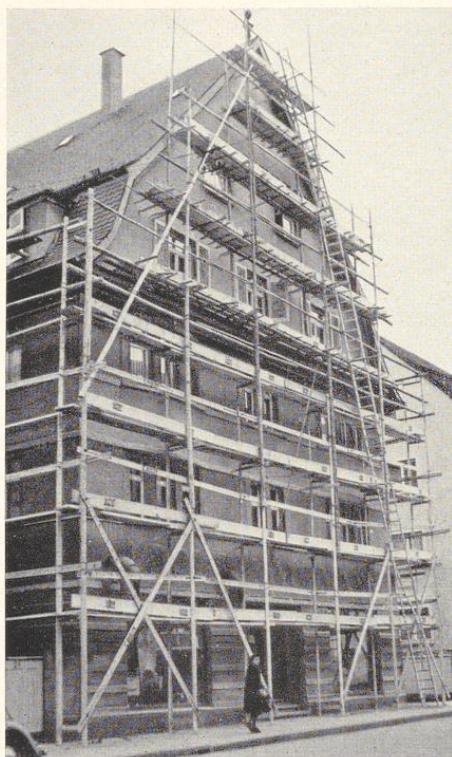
Einfaches Leitergerüst mit Doppelstangengerüst
